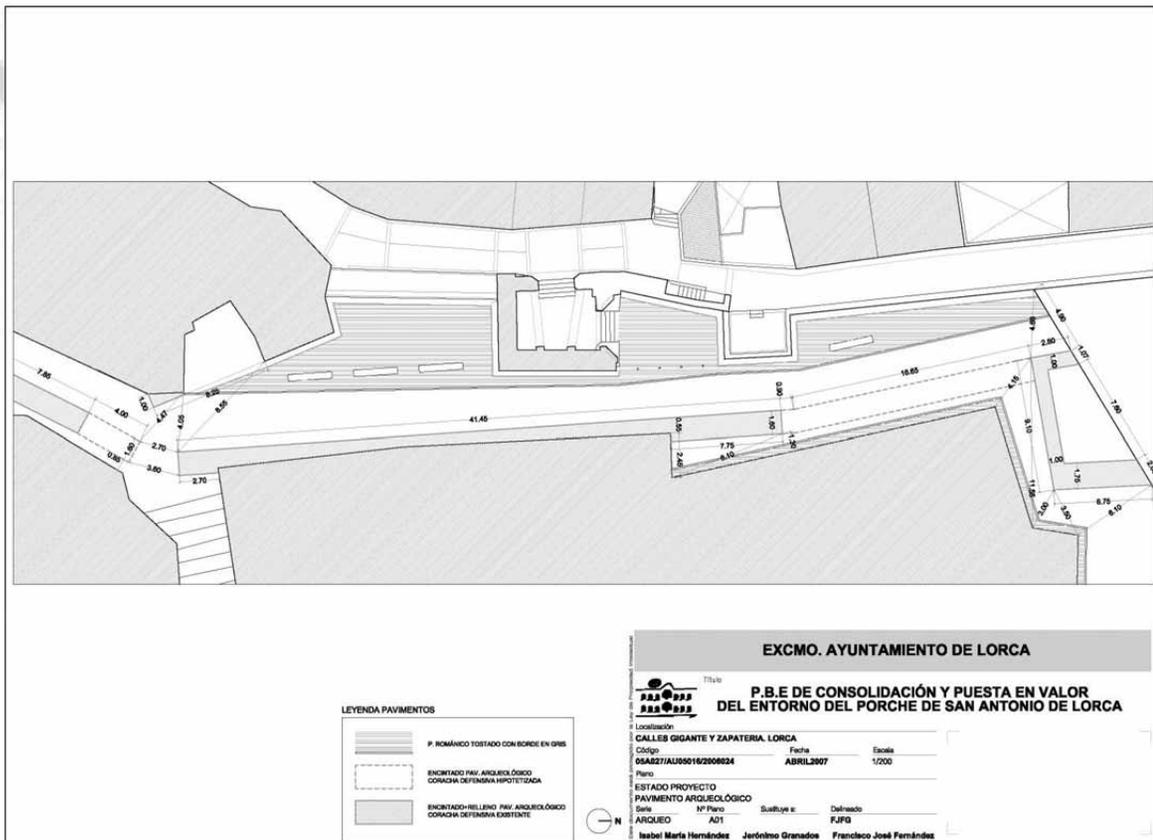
Plano de pavimentación sobre los restos de la antemuralla.
